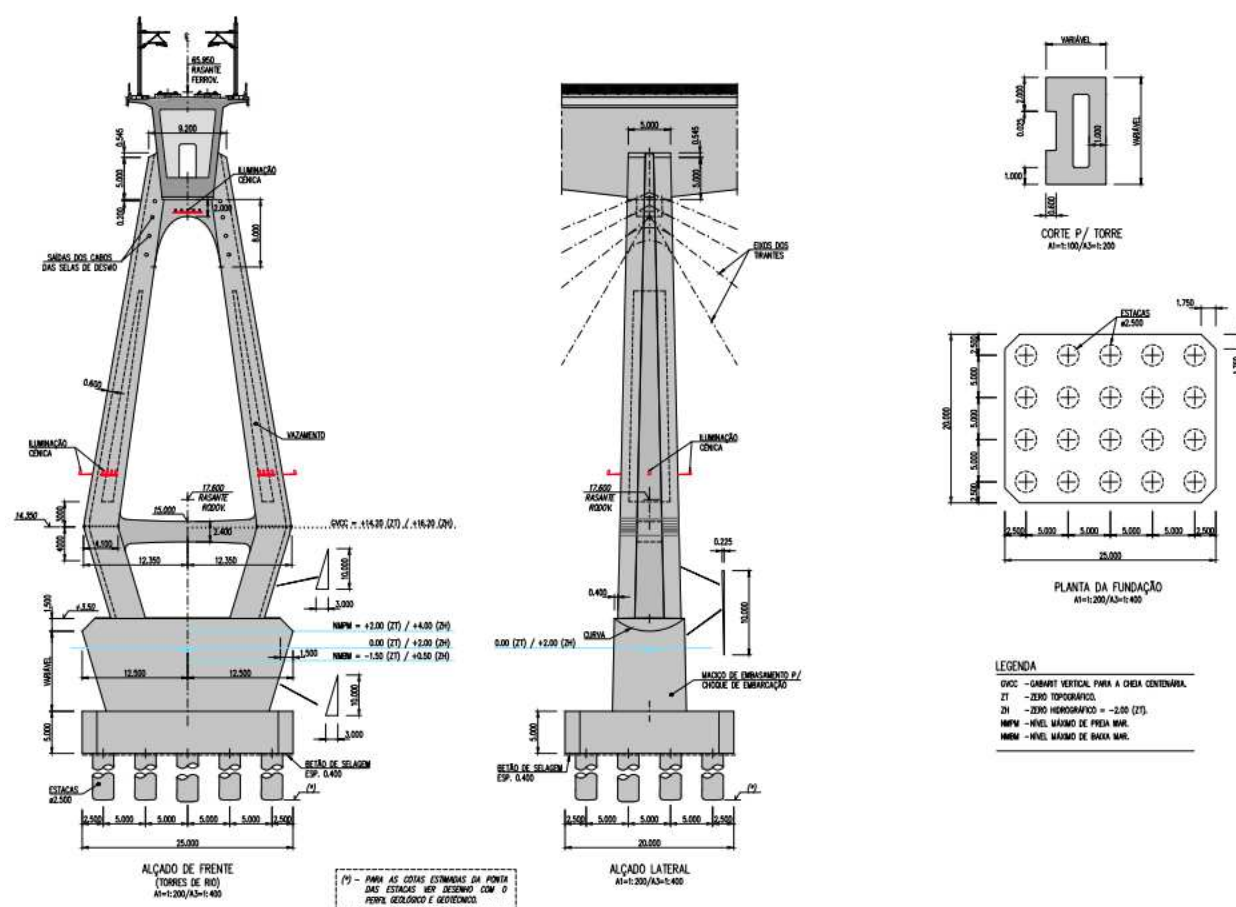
Geometria dos pilares T1 e T2 da travessia ferroviária.
